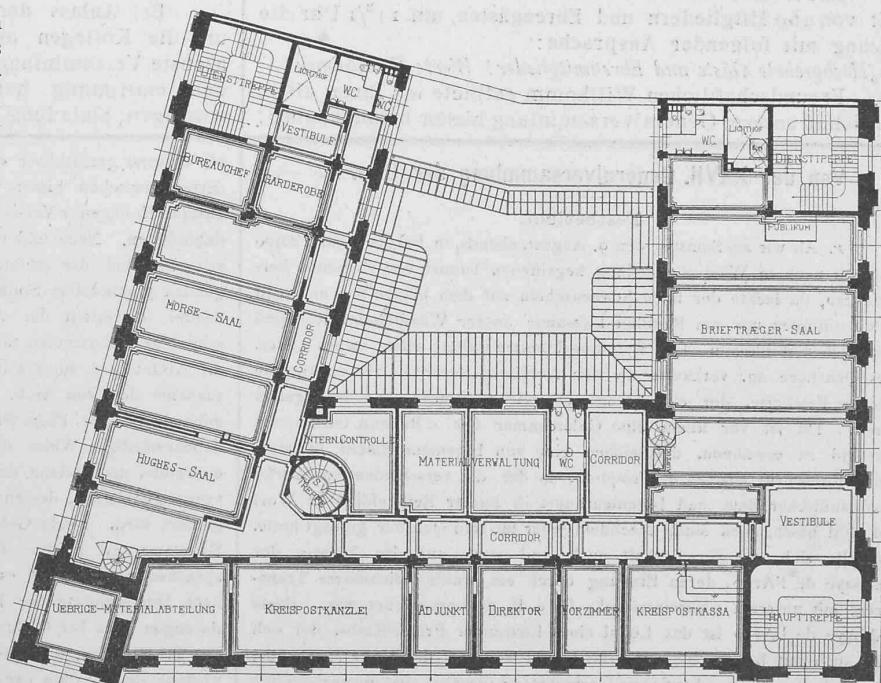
Grundriss vom I. Stock. — Maßstab 1:500.
